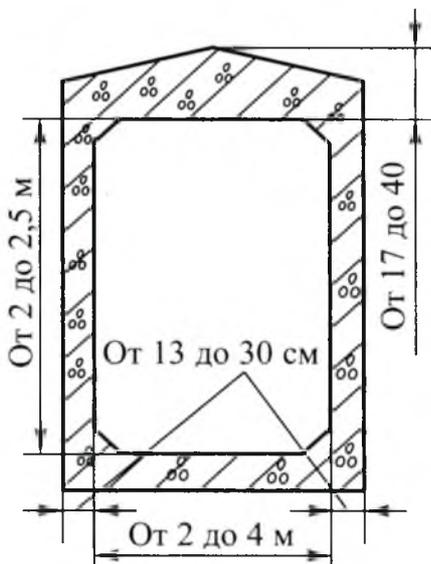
Конструкция прямоугольного звена железобетонной трубы
